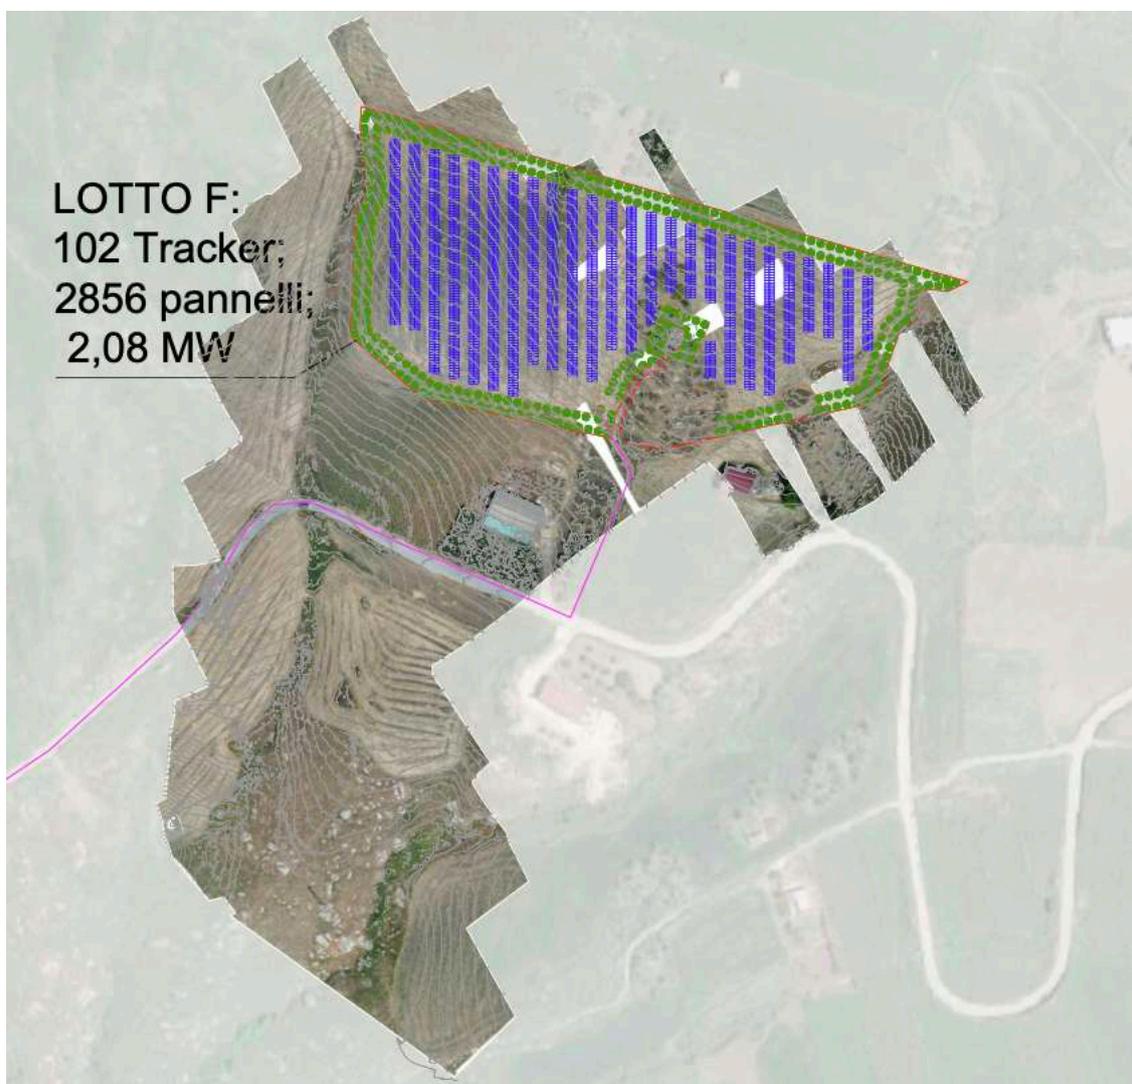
Particolare Layout di impianto area F su stralcio rilievo
